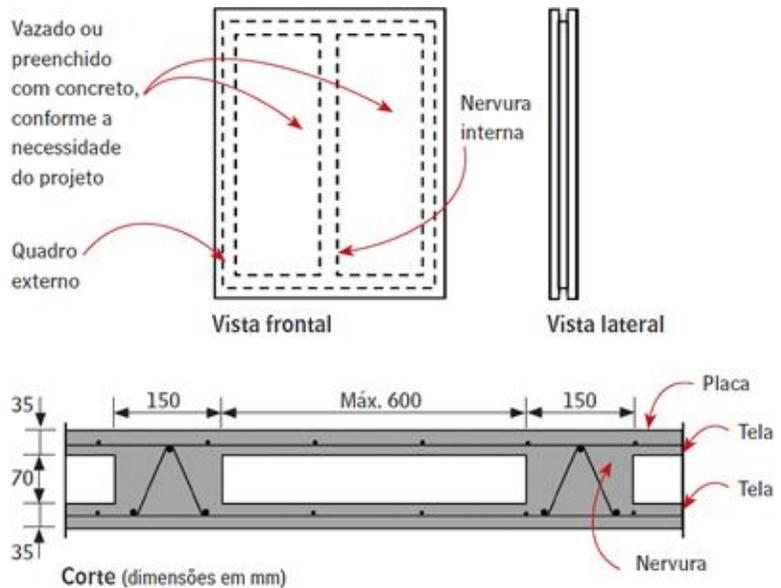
Esquema geral do painel – Detalhe da união das placas de concreto armado, feita por um quadro interno e nervuras internas de concreto
